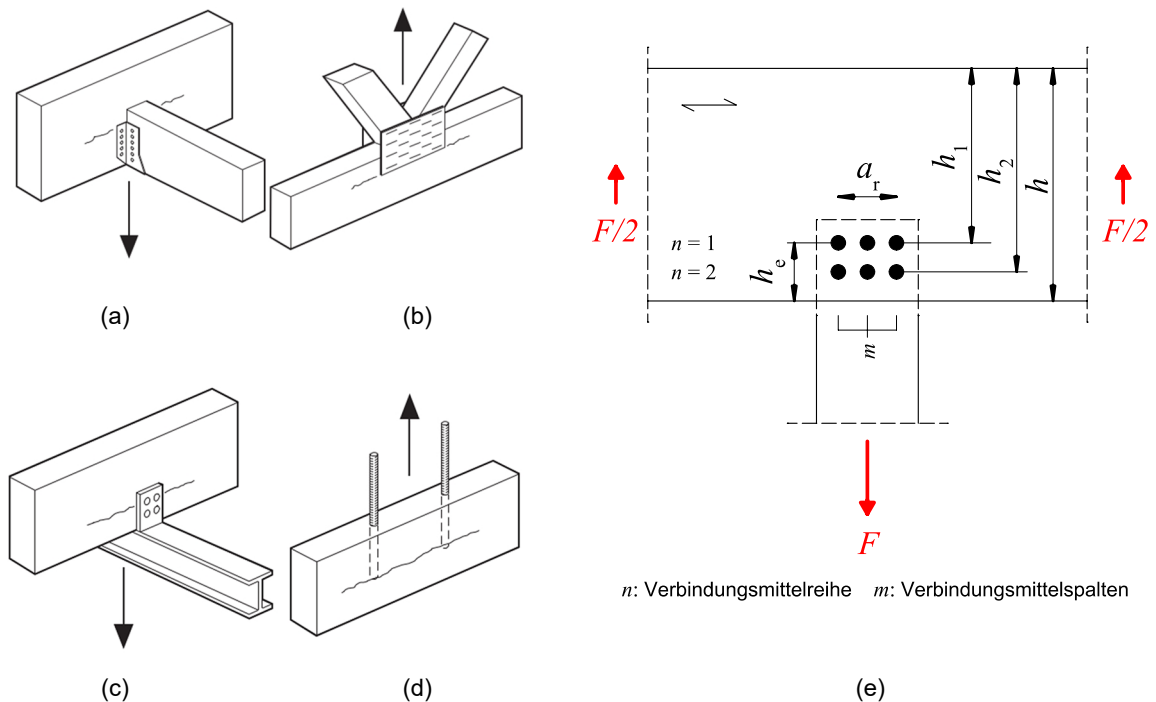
Queranschlüsse mit wahrscheinlichen Querzugrisse: (a) Balkenschuh, (b) Nagelplattenanschluss, (c) Anschluss mit Stabdübeln oder Dübeln besonderer Bauart, (d) eingeklebte Gewindestangen. Bild mit Spannungen und Queranschlüssen (Blaß und Sandhaas 2016), STEP 1995 Beitrag C 2; (e) Bezeichnung der geometrischen Parameter von Queranschlüssen
